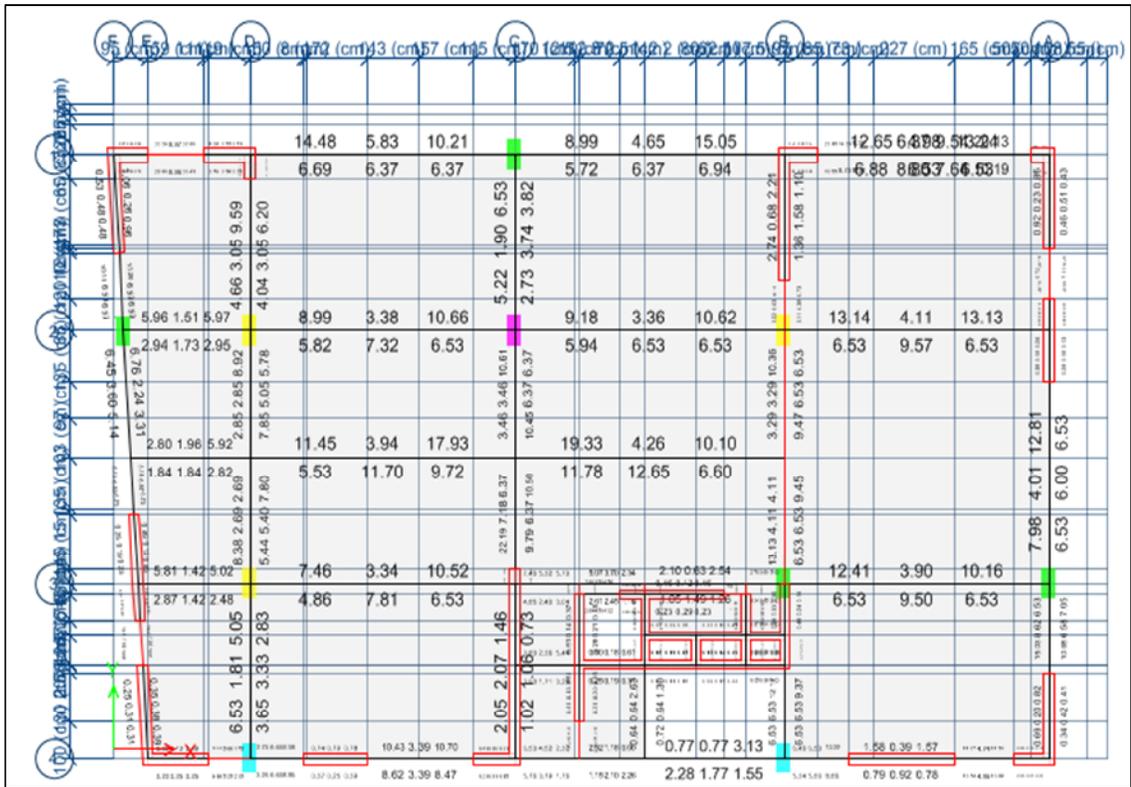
Datos Calculados por ETABS 2015 para Obtener el Acero Máximo para la Viga a Diseñar (cm2).
